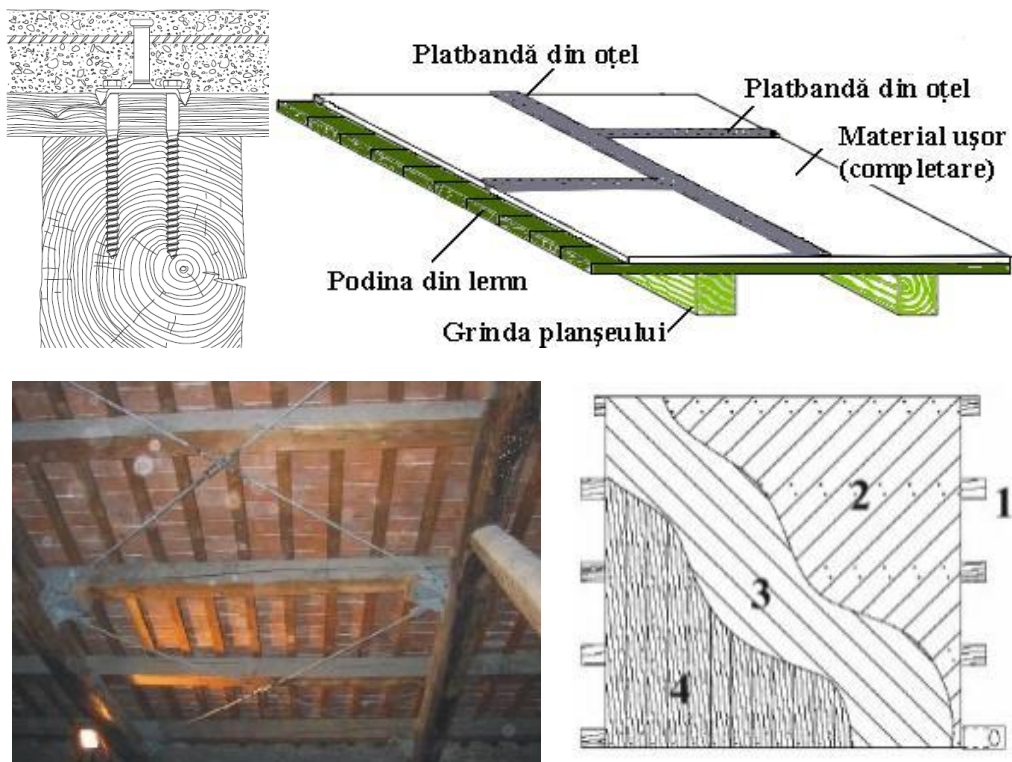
Variante de consolidare a planșelor din lemn.
